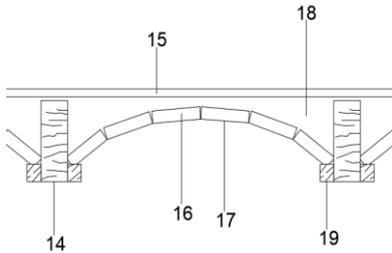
Detalle constructivo Forjado Unidireccional. Fuente: Propia de la autora
